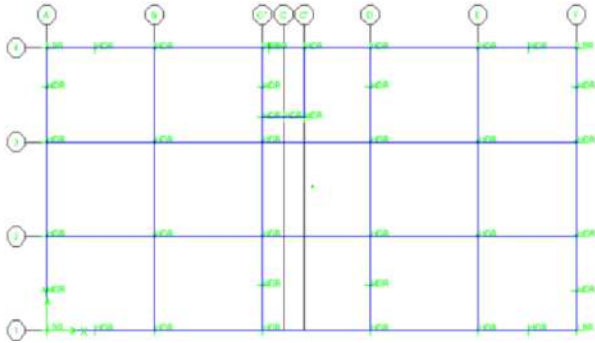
Vista en planta de la combinación de los aisladores HDR y LBR. Fuente: Elaboración propia.
